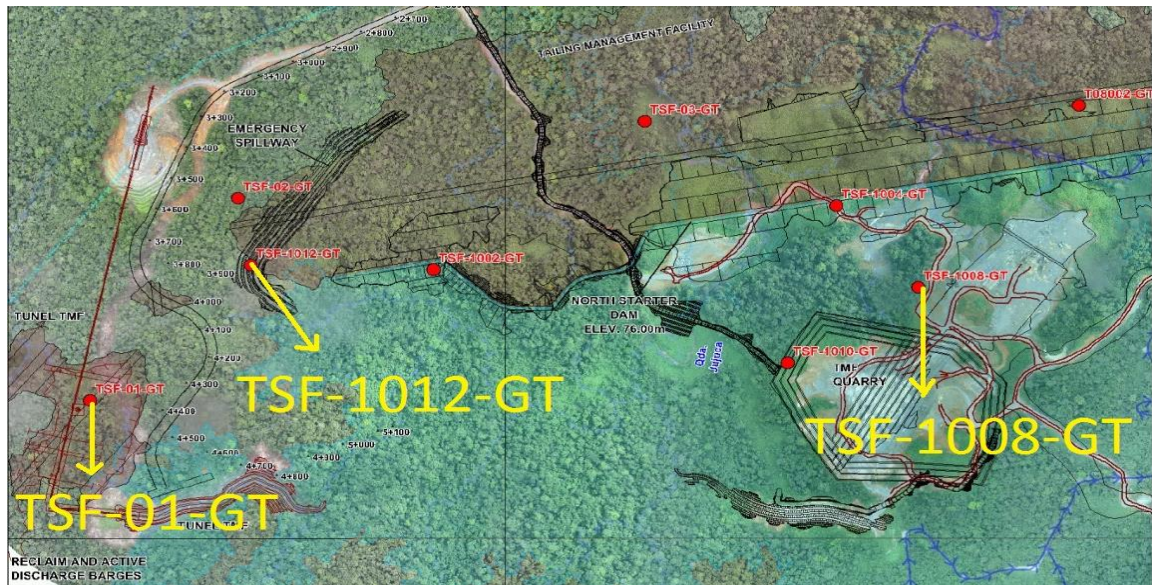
Pozos ubicados en la parte oeste de la Tailing, TSF-01-GT y TSF-1012-GT y en la parte norte de la cantera TMF, TSF-1008-GT
